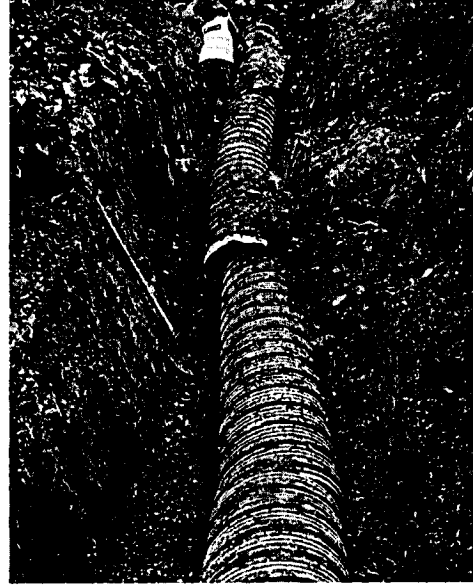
Complemento de la imagen anterior donde se aprecia estado de la tubería y alineamiento aguas arriba.
